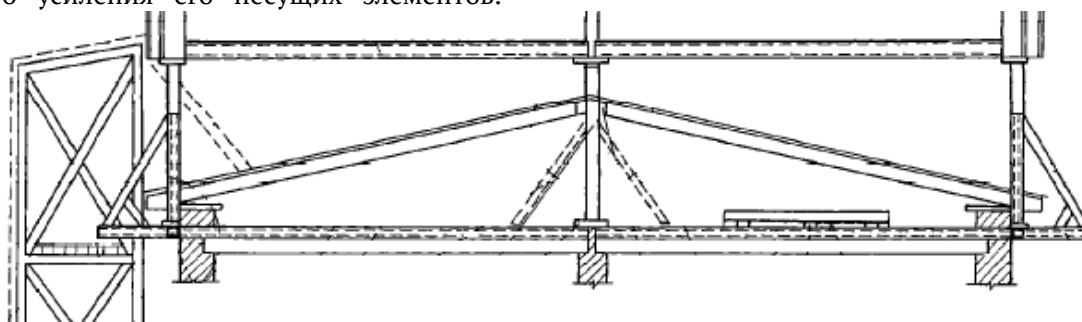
Поперечный разрез реконструируемого здания после реконструкции
